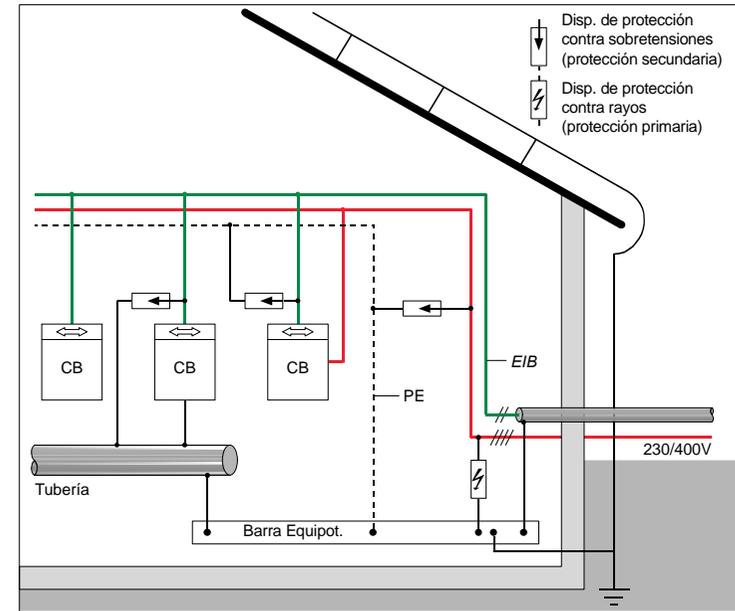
Conexión de dispositivos de protección contra sobretensiones con cables trazados en canalizaciones o tuberías metálicas
